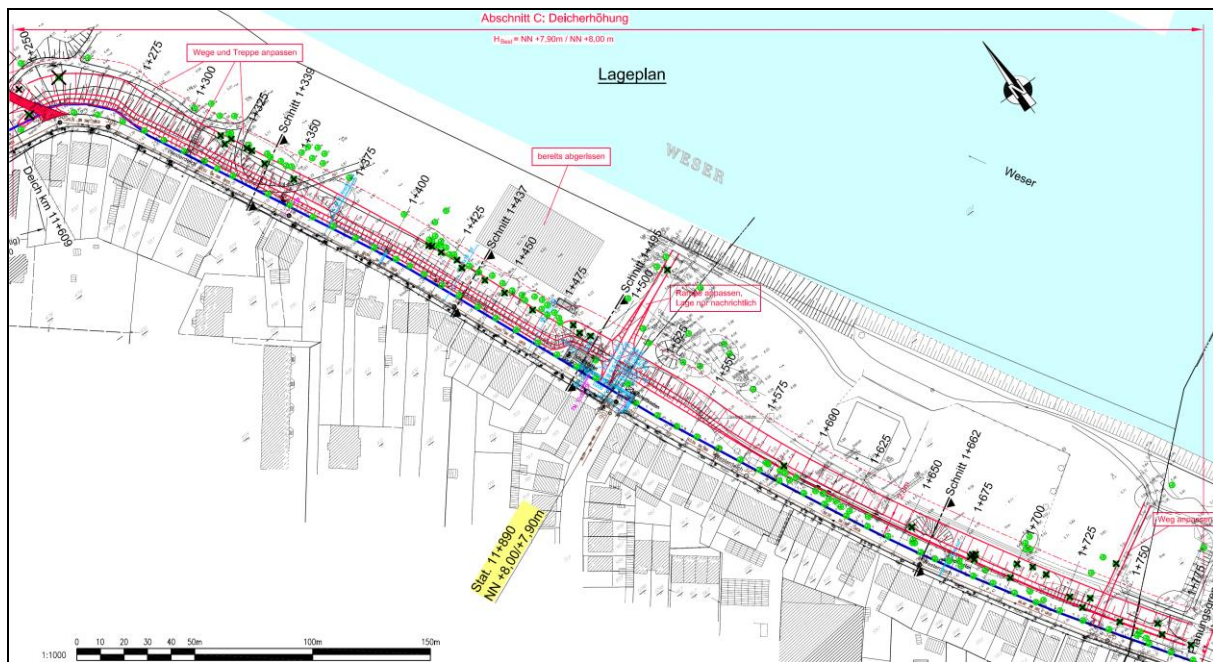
Rahmenentwurf Abschnitt C – Ausschnitt Lageplan (IL 2013)
